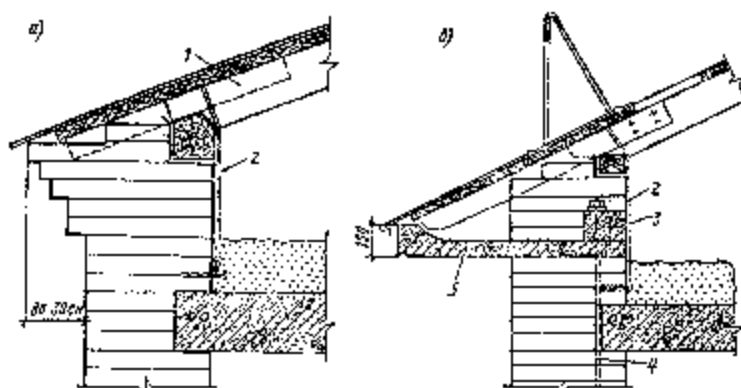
Венчающие карнизы: а – кирпичные; б – из сборных железобетонных плит; 1 – кобылка; 2 – скрутка; 3 – анкерная балка; 4 – анкер; 5 – карнизная плита.
